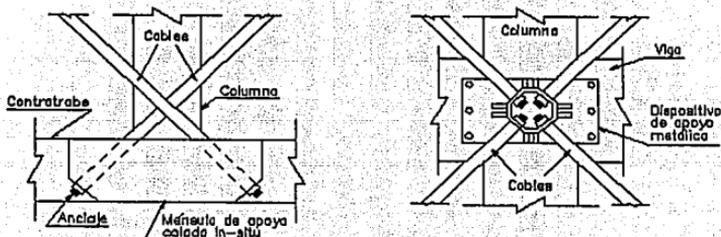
Edificio escolar típico rigidizado y reestructurado con cables de presfuerzo.
